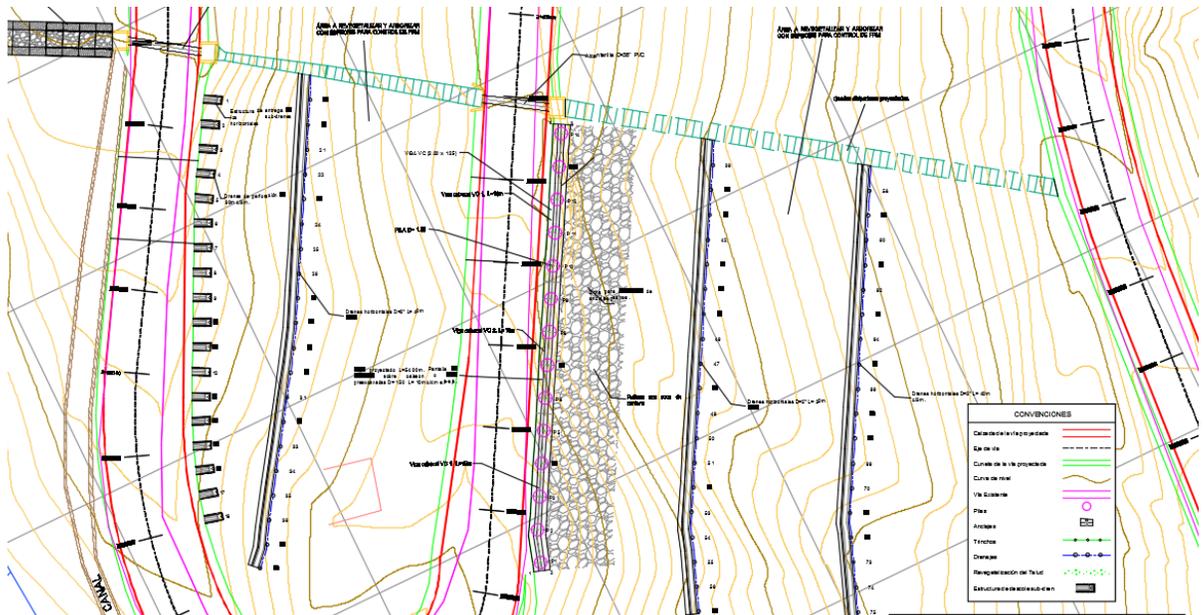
Vista en planta de las obras del sector La Chaconia. Fuente: Diseños UT CONSULVIALES
